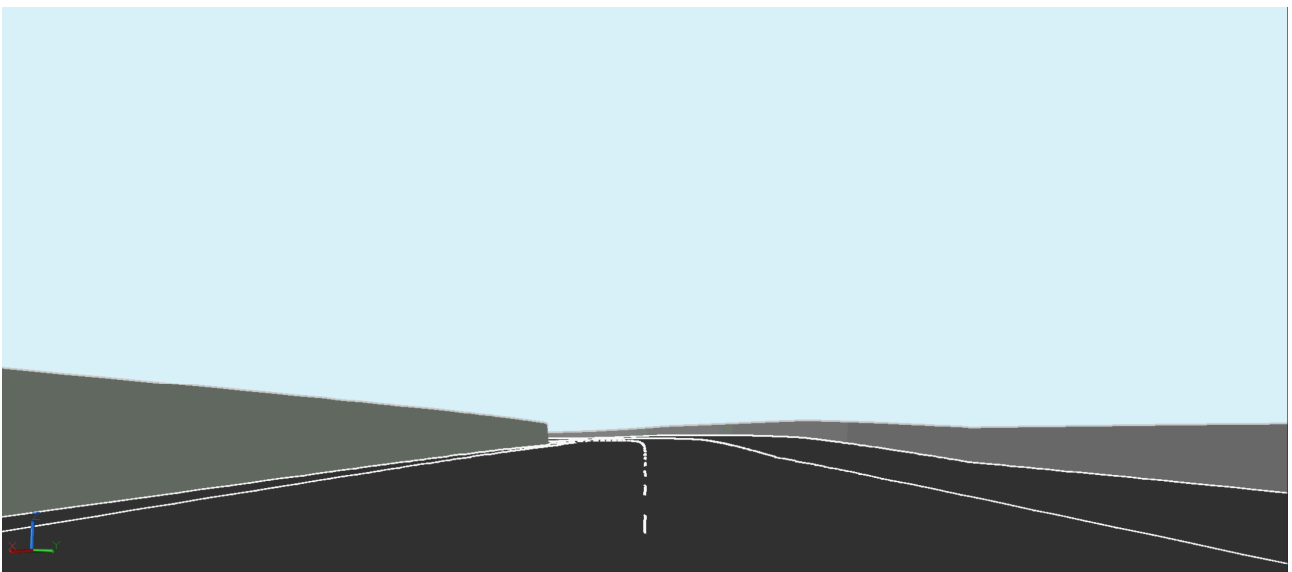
Visione prospettica in ingresso alla curva planimetrica 6 (Carr. FA-GR)
